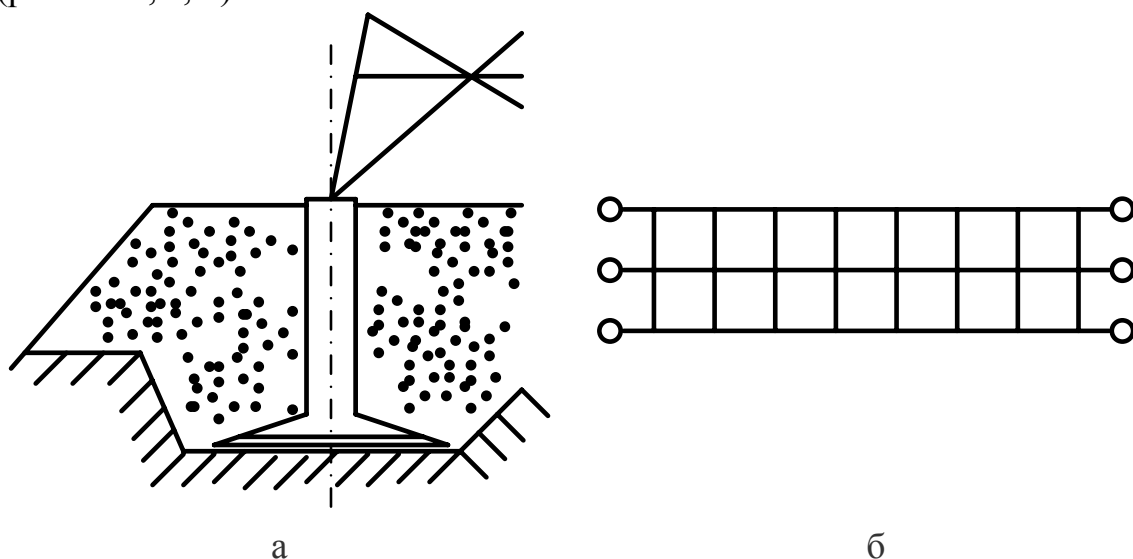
Защита фундамента: а – насыпным грунтом; б – устройством для защиты от льдин
